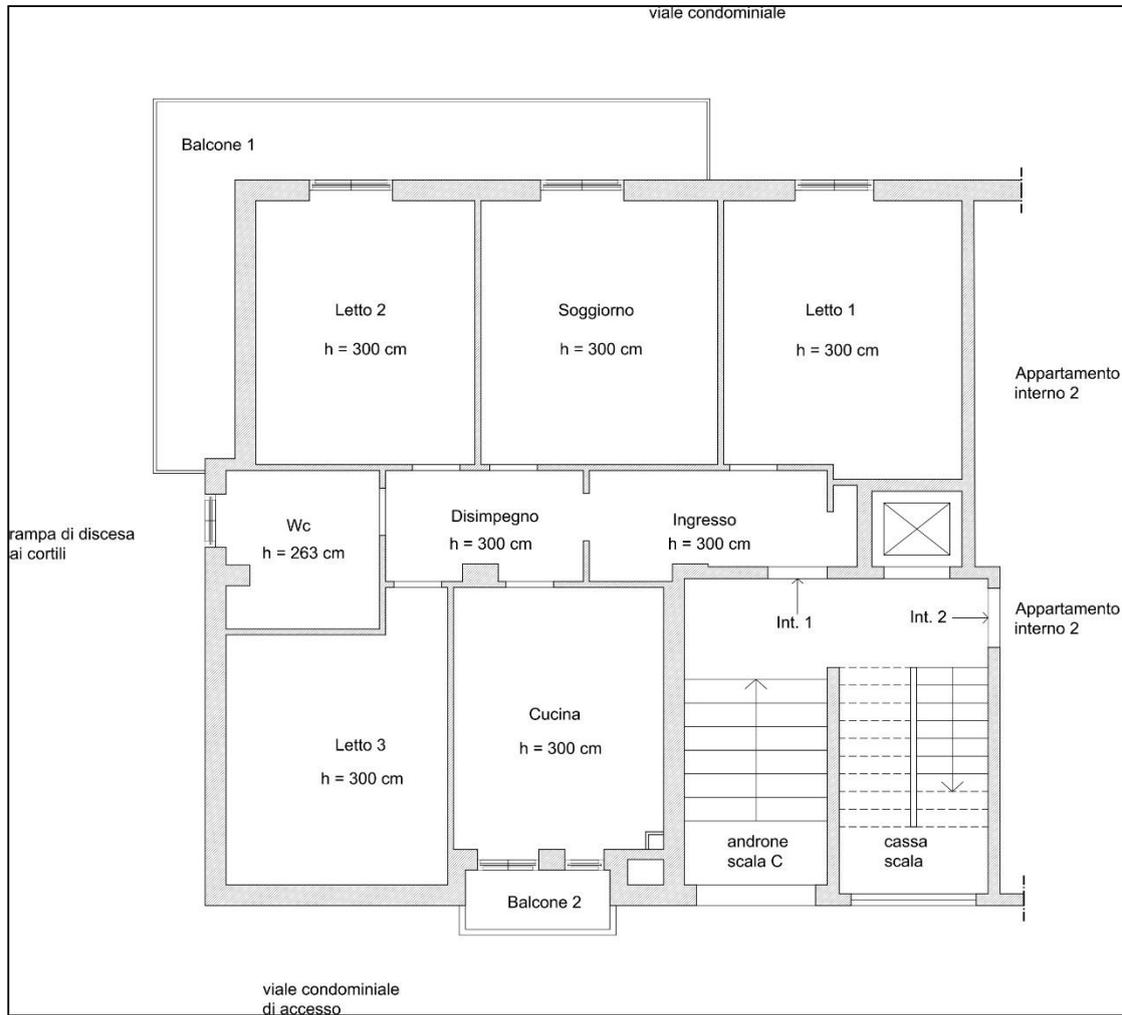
a\_Planimetria di stato attuale dell'appartamento (int.1) di via Diaz n.3d
